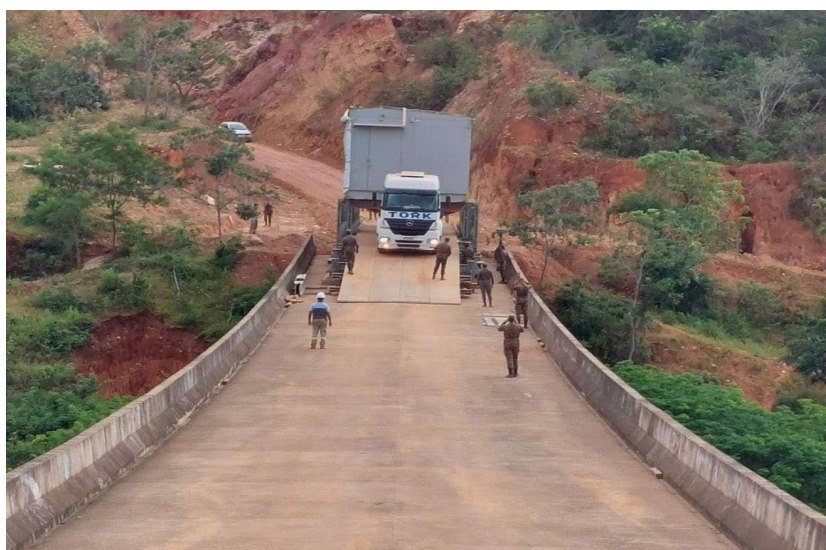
Estrutura de concreto que existe no local precisou ser interditada e Exército foi mobilizado para medida provisória, uma ponte metálica
